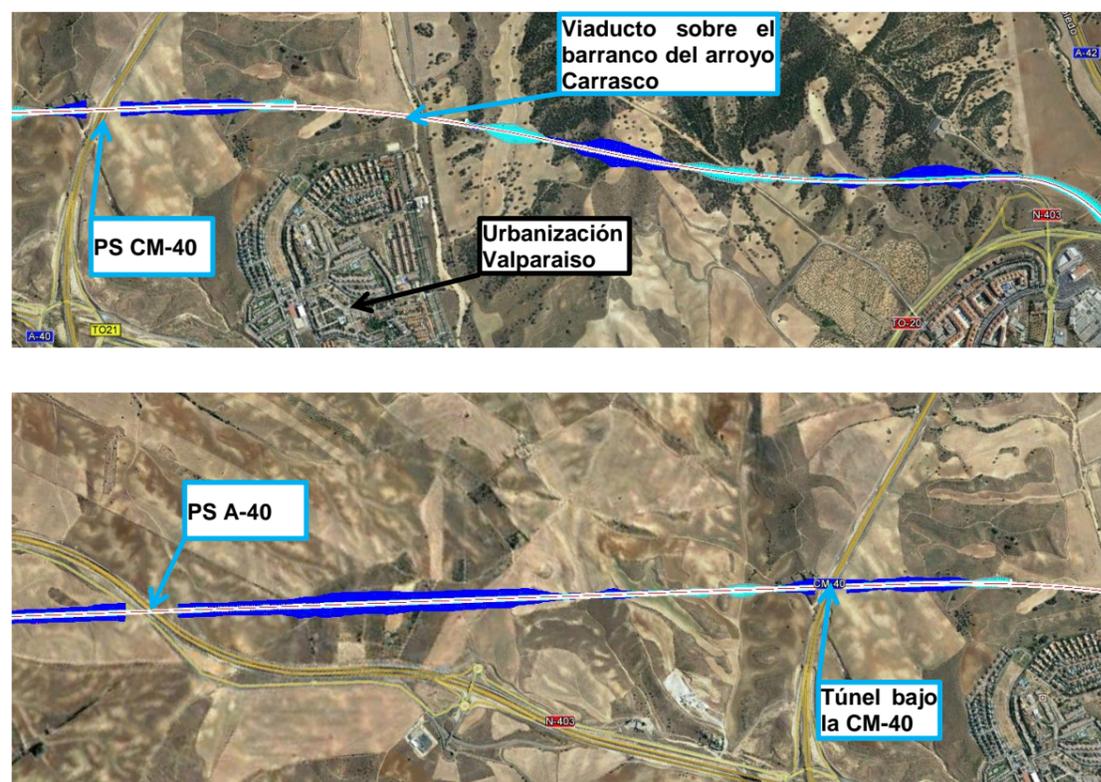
Trazado de la nueva LAV Madrid – Extremadura (Alternativa I.2) desde la salida de Toledo hasta el cruce bajo la Autovía A-40.
